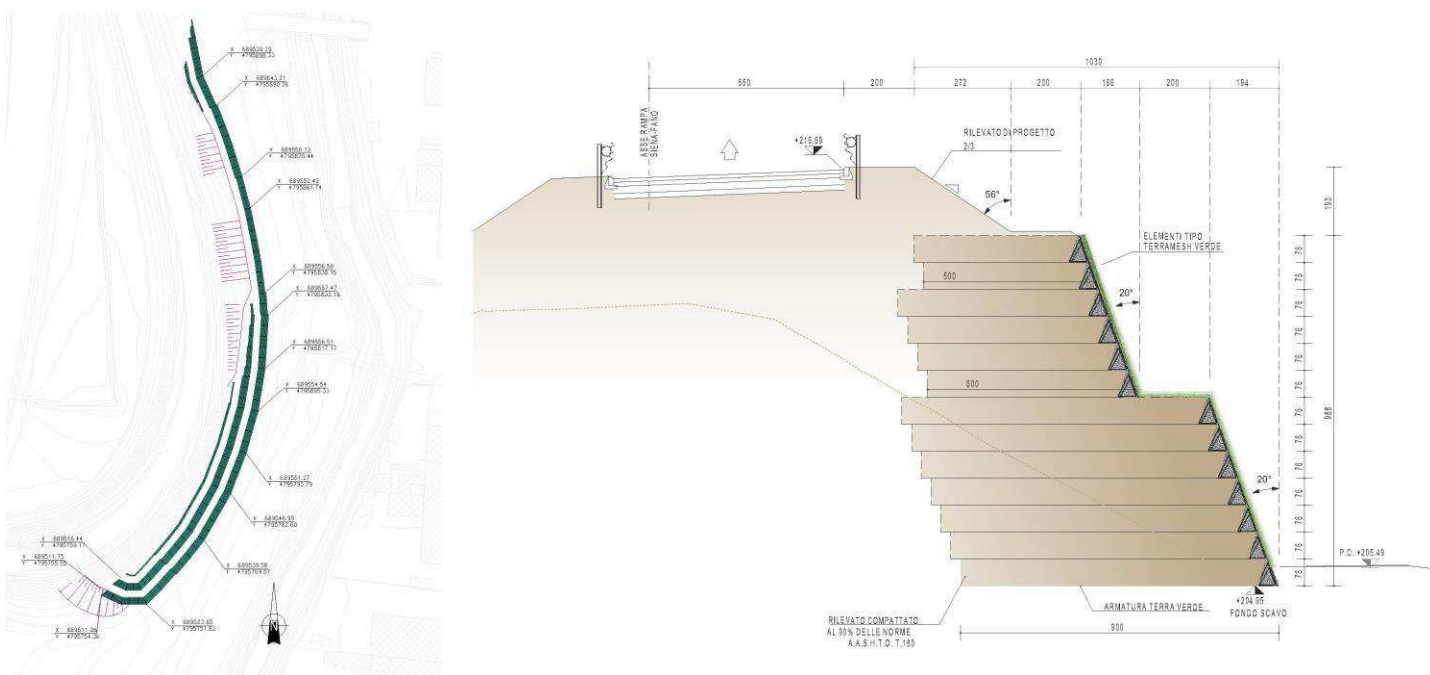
Pianta e sezione dell'intervento in terra mesh
